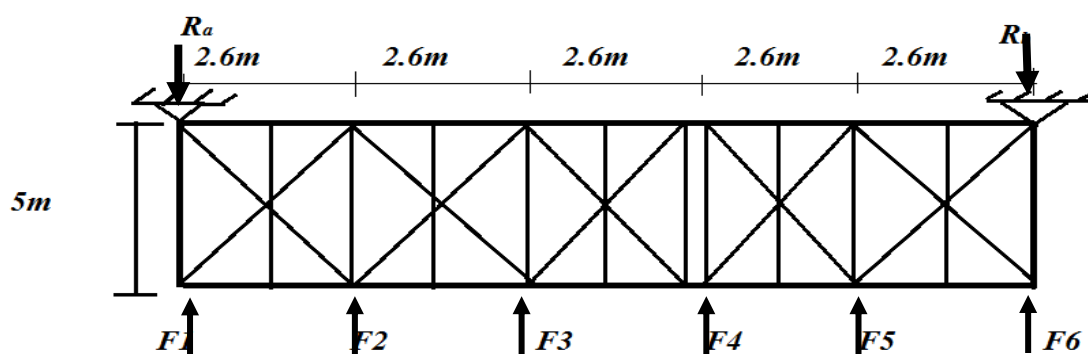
Schéma statique de la poutre au vent en pignon.
